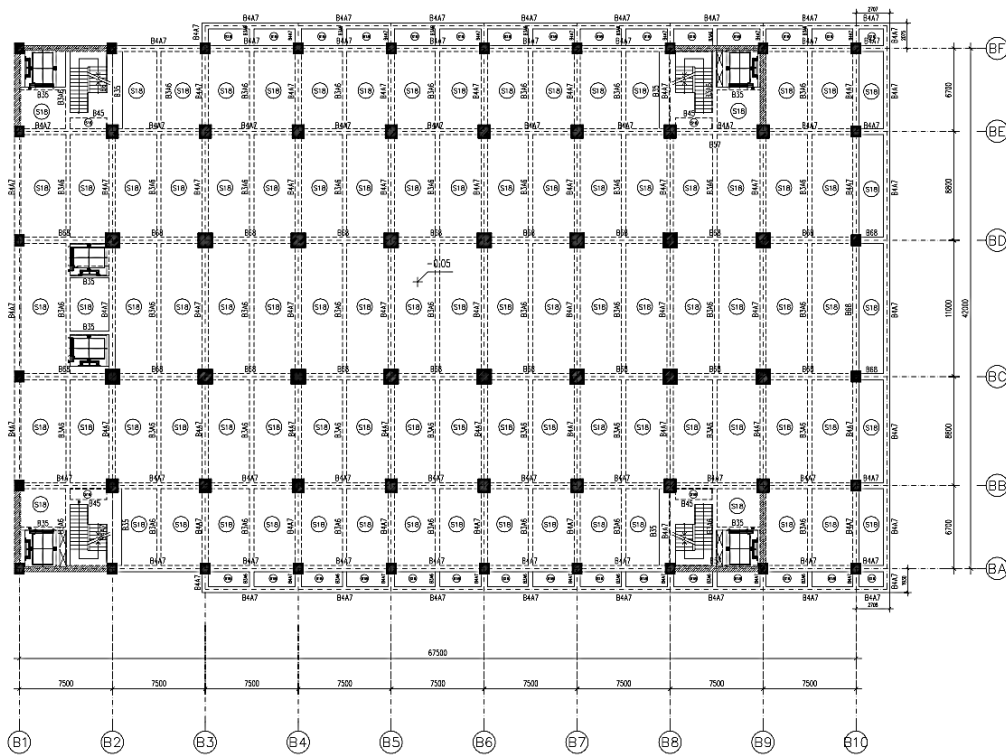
Denah pembalokan Lantai 1 Gedung Pelayanan
